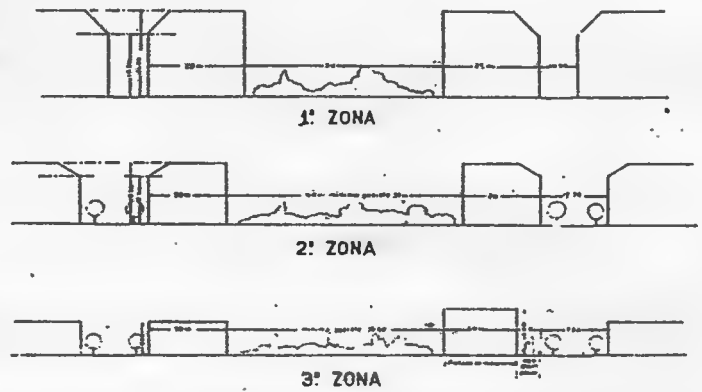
/ A la derecha / Secciones transversales para alturas generales de edificación / No se podrá construir en los centros de manzanas, excepto en el subsuelo y planta baja de la 1ª zona
